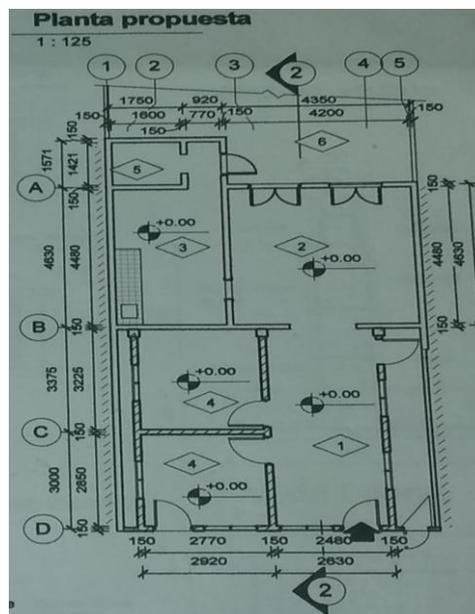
Planta de la vivienda de Tipología I. Fuente: Foto tomada por la autora al informe del proyecto facilitado en Planificación Física.
